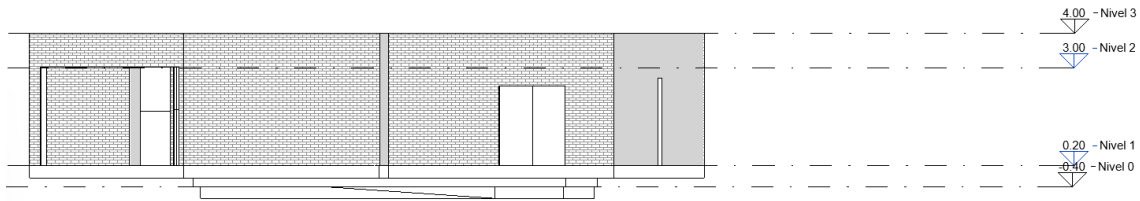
Alzado Sur modelo levantamiento con iPhone. Fuente: elaboración propia.
